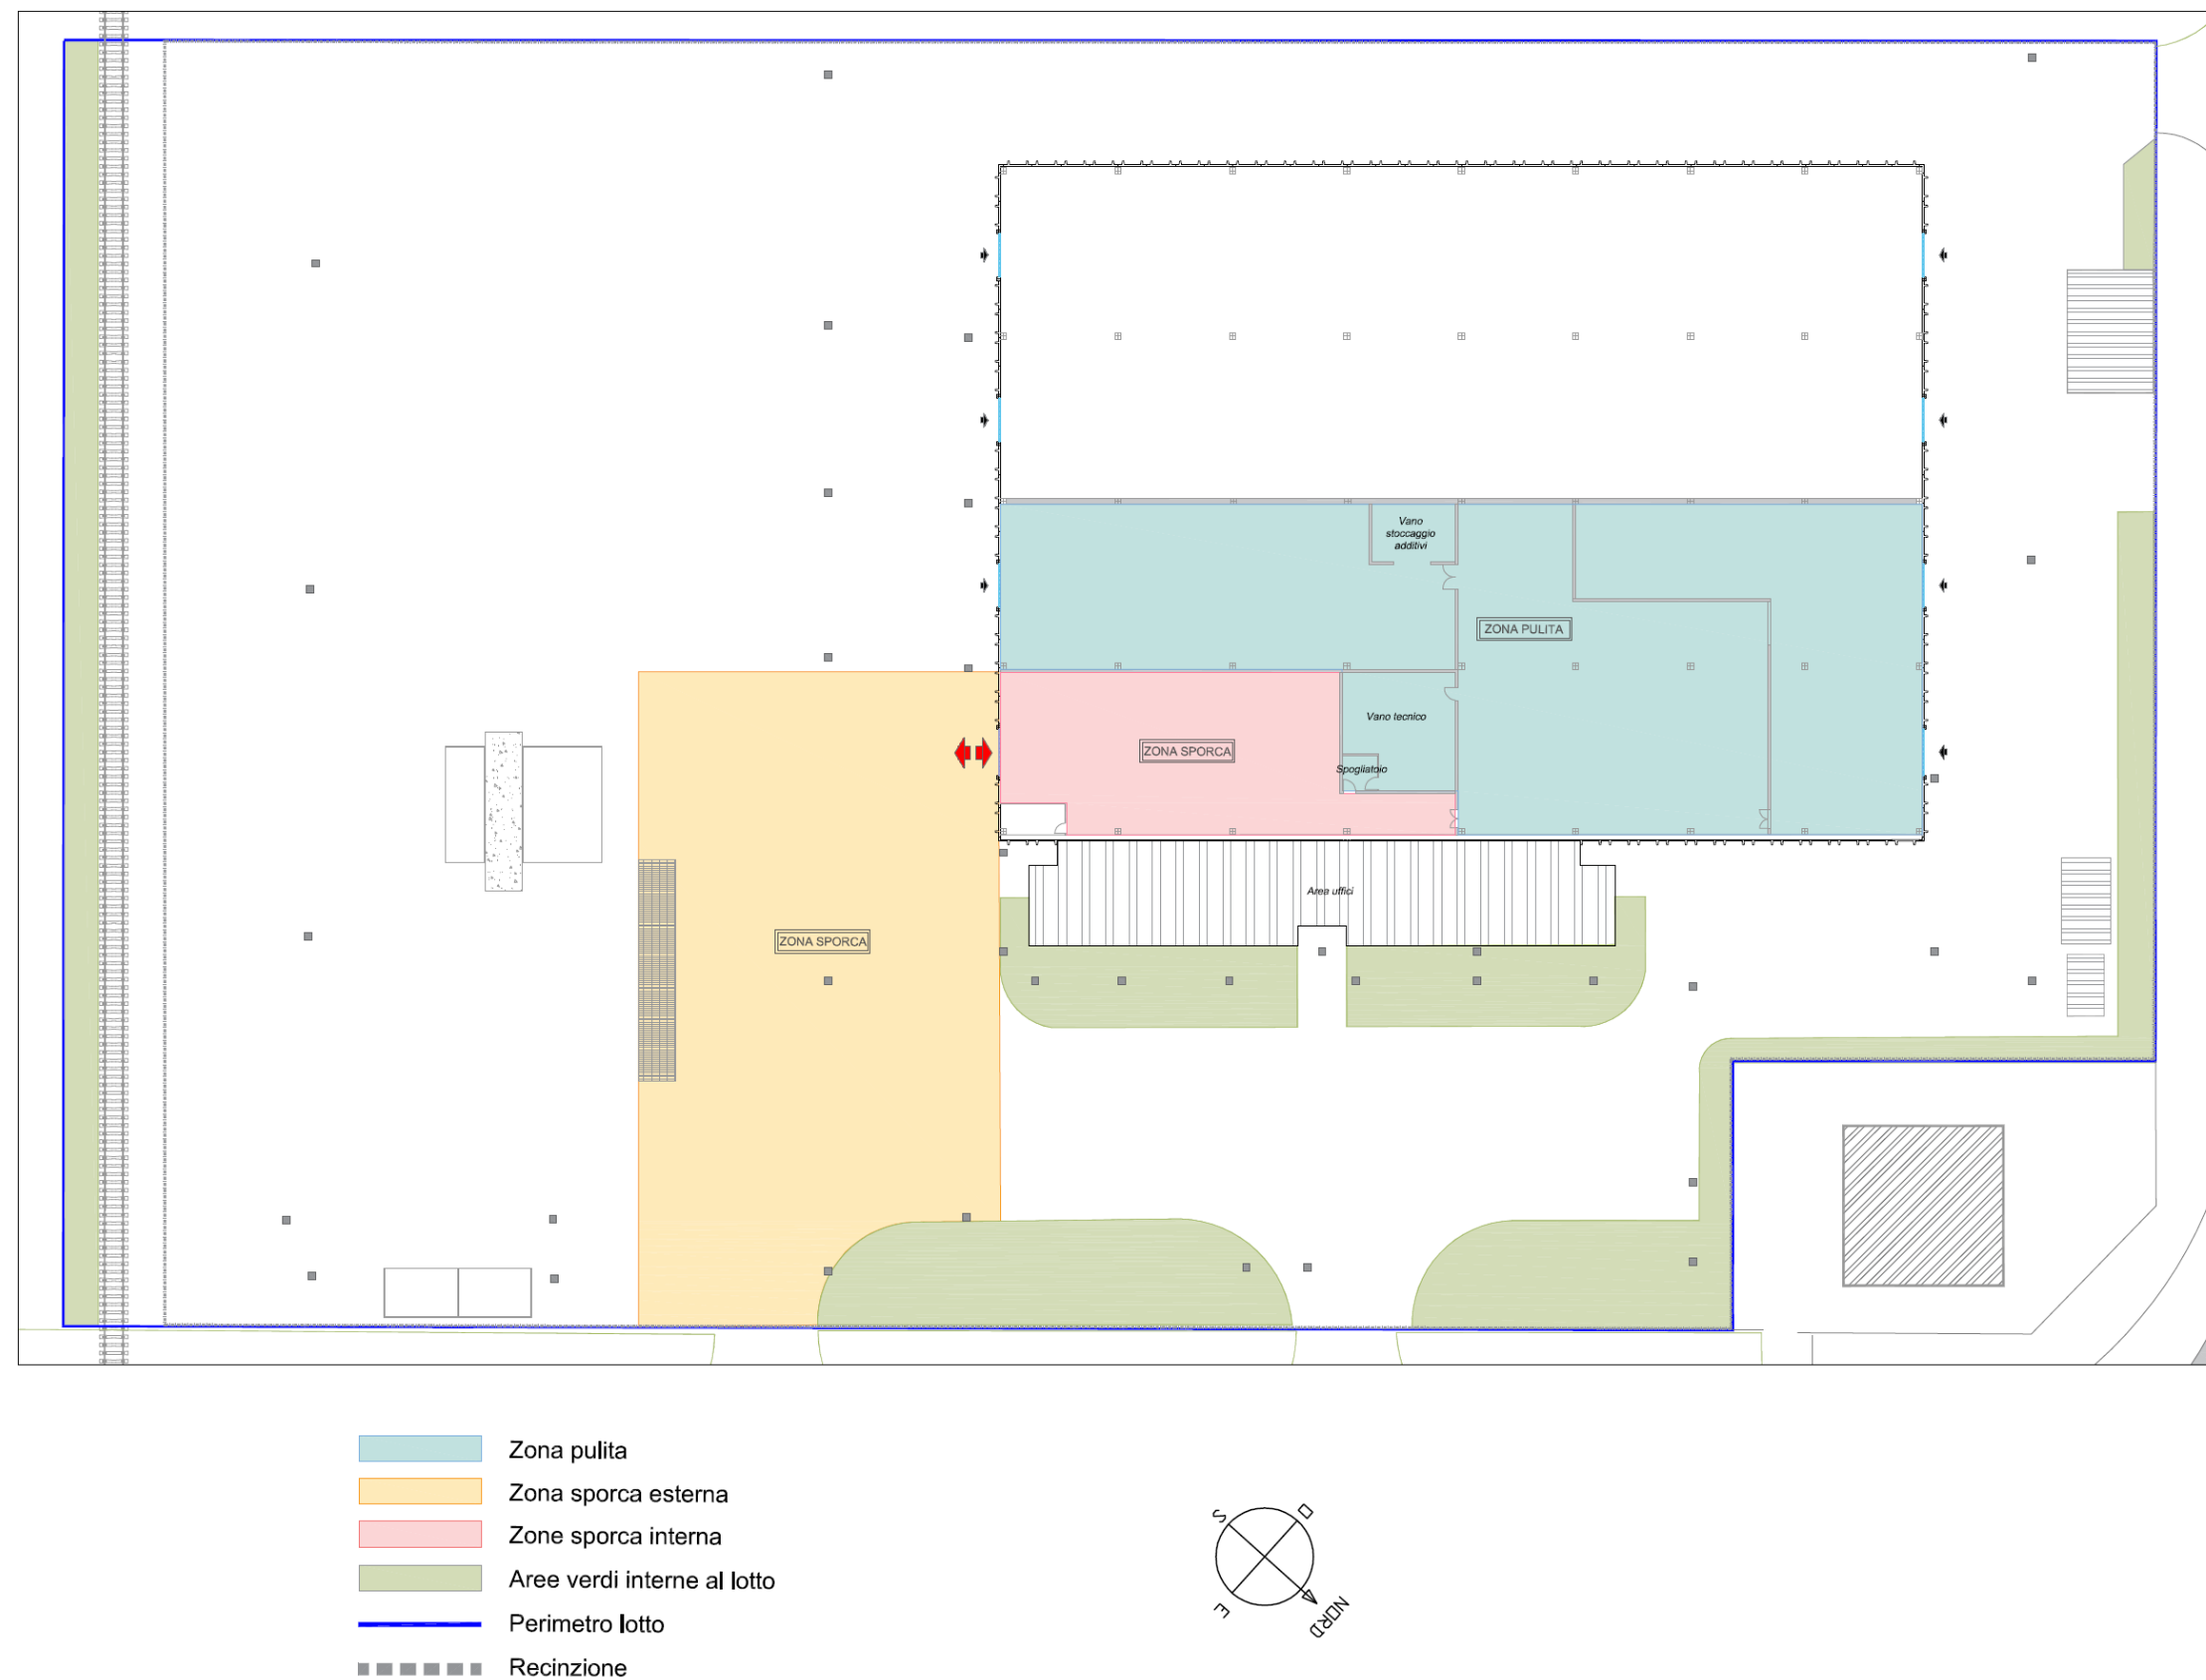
/I: Planimetria suddivisione aree (Reg. EU 1069/2009)
